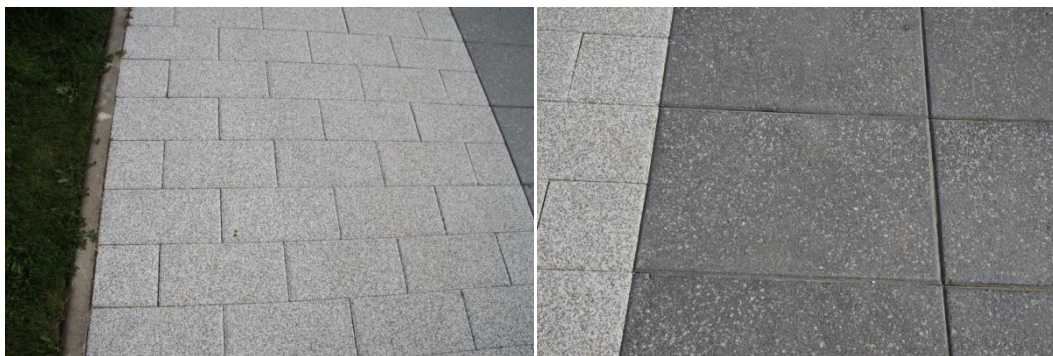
y 5: Pavimento colocado en la acera perimetral.
